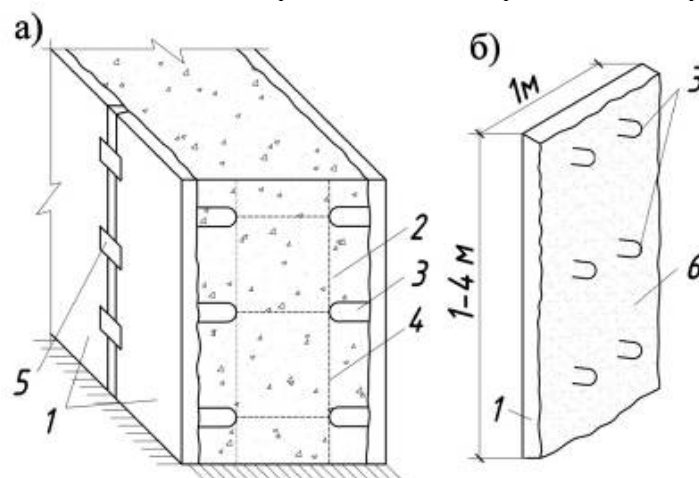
Конструкция стен из тонкостенных железобетонных элементов:
